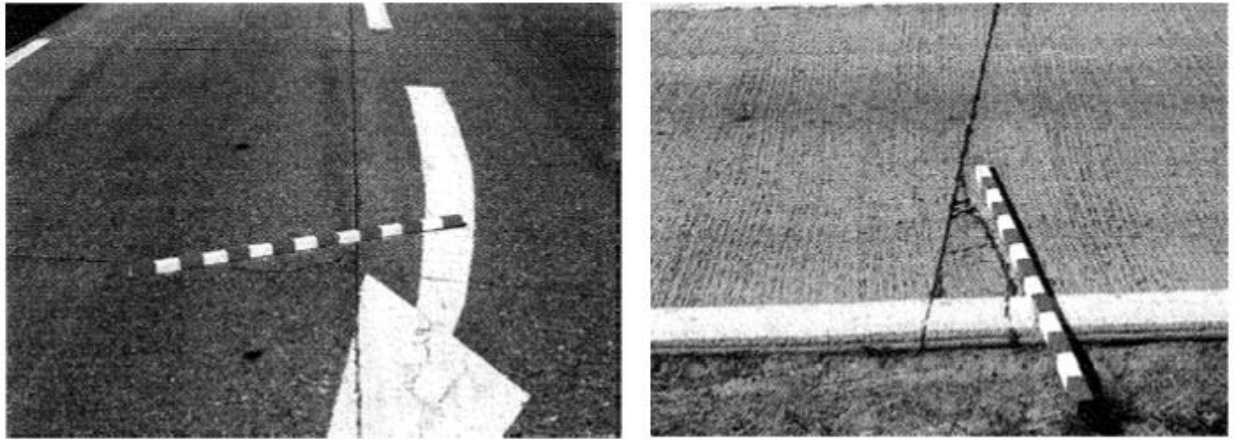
Cassure d'angle d'une chaussée rigide
